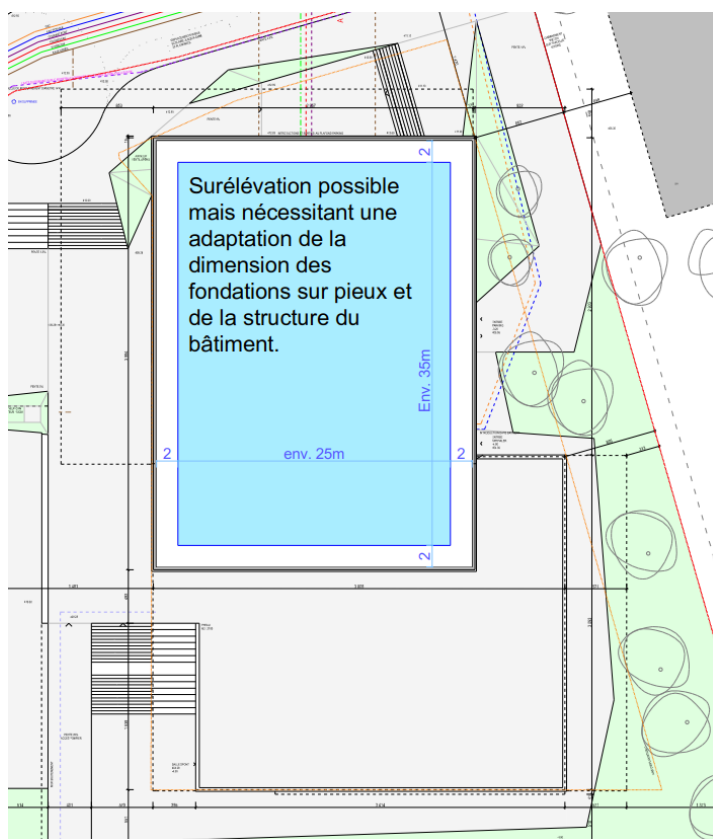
Toiture du collège Croset-Parc – Variante de surélévation sur une large partie de la toiture.
